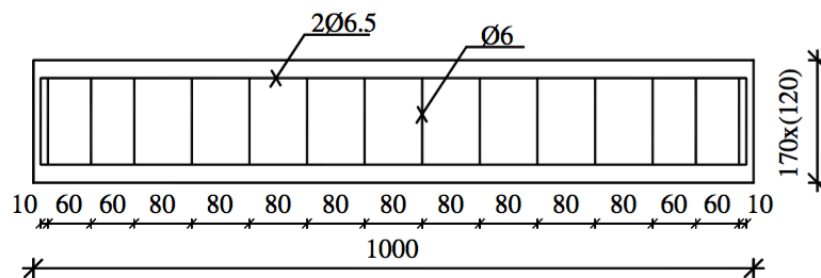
Seção longitudinal das vigas (Fonte: Barros *et al*, 2007)
